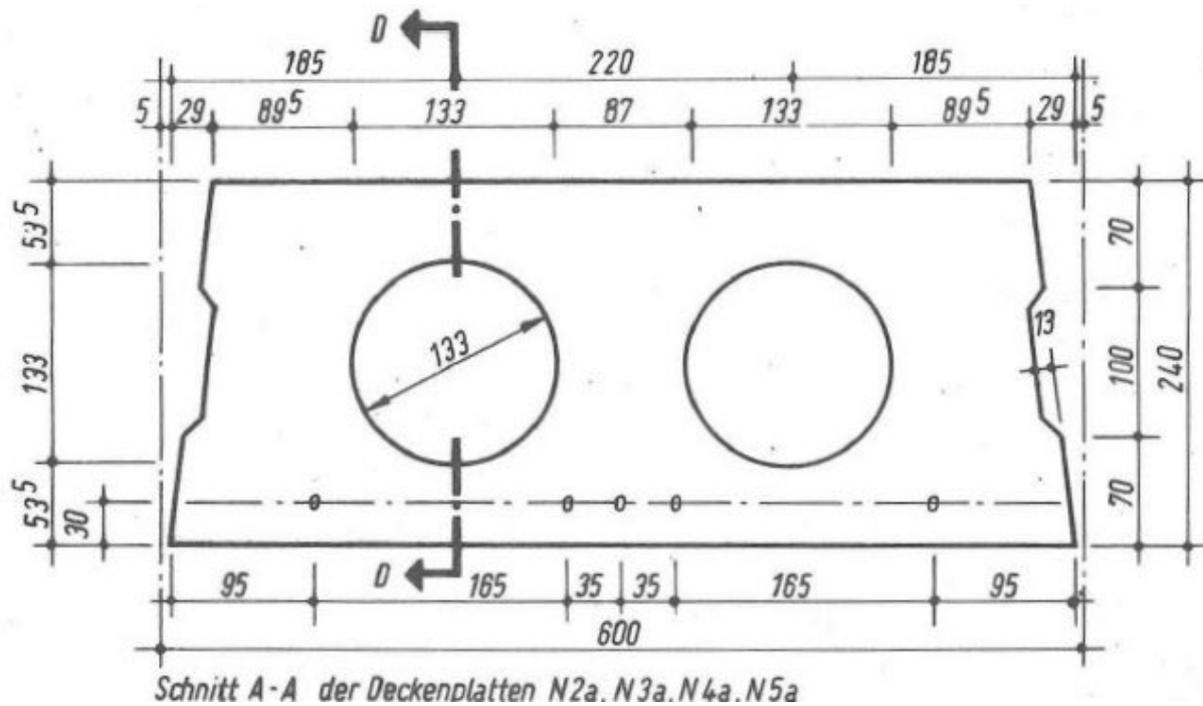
Spannbetondeckenplatte, im sofortigen Verbund, [1], Bild 128
